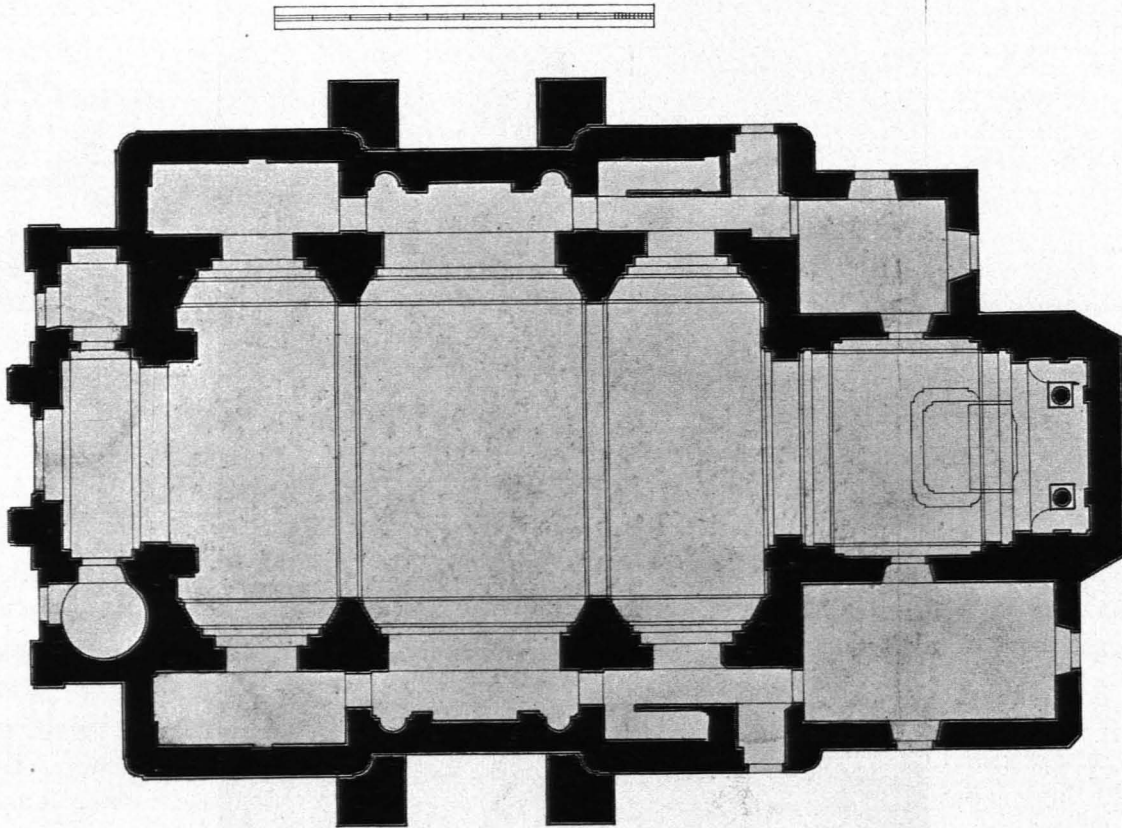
Säusenstein, Pfarrkirche, Grundriß (S. 406)
